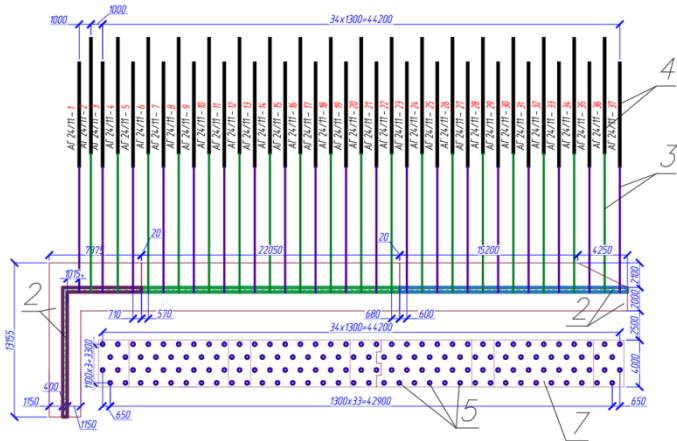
Схема устройства монолитных железобетонных ростверков и диафрагм на завершающем этапе: 1 – призматические железобетонные сваи; 2 – существующий монолитный уголкового железобетонный ростверк; 3, 4 – грунтовые анкера ЭРТ; 5 – буроинъекционные сваи ЭРТ усиления основания; 6 – монолитные железобетонные контрфорсы; 7 – монолитный железобетонный ростверк
